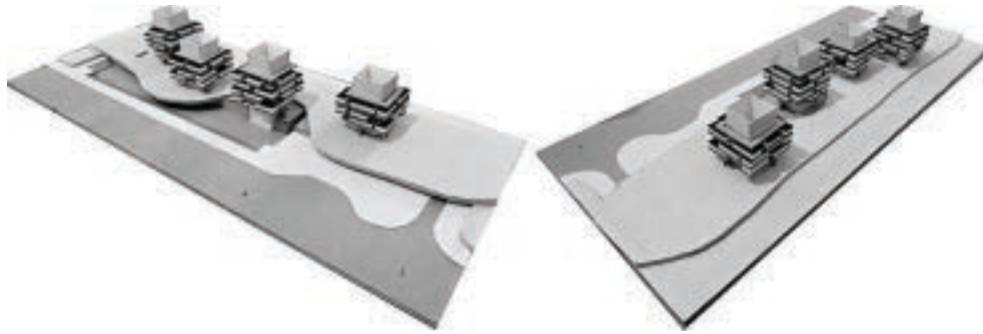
Maqueta 1:500 da 1ª fase da proposta de intervenção (hotel). (Ilustração nossa)
